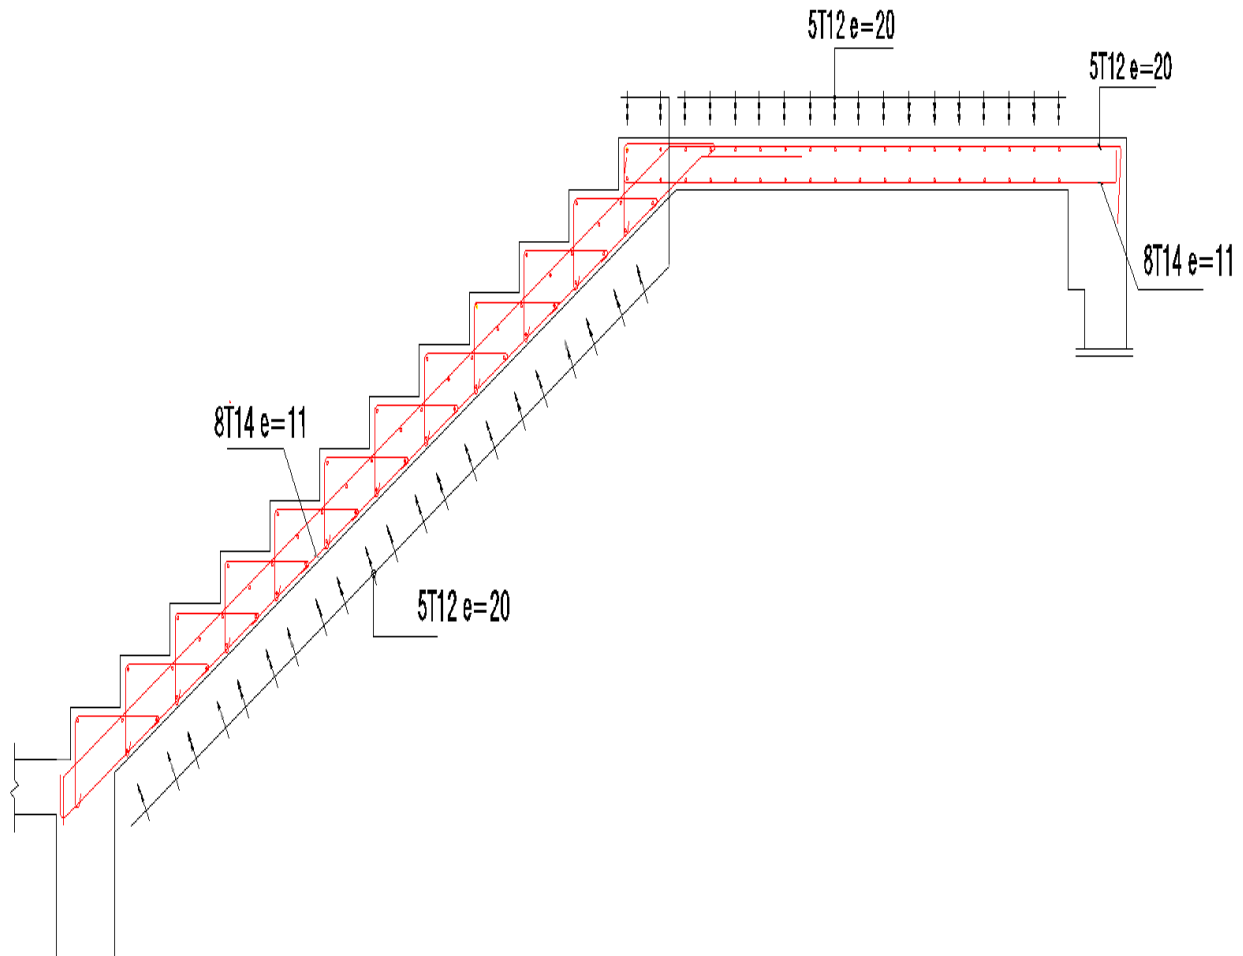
Schéma de ferrailage de l'escalier de deux volées
